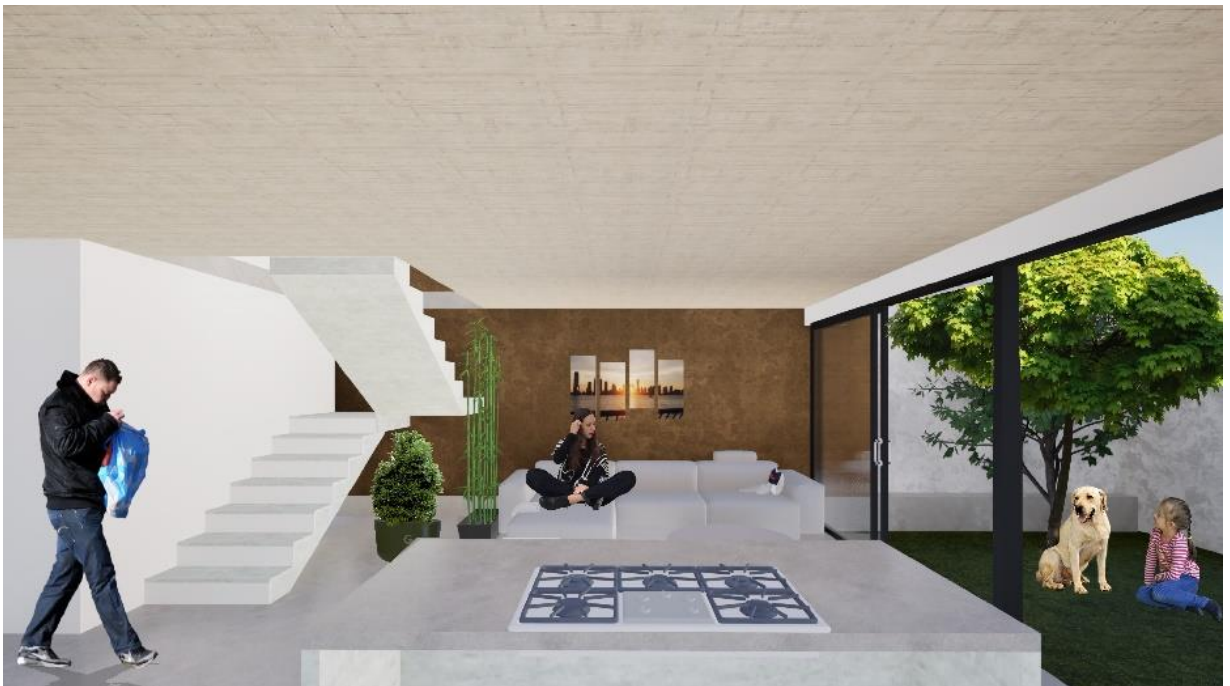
Vista interna de la planta baja del patio interno y externo del proyecto VIP
